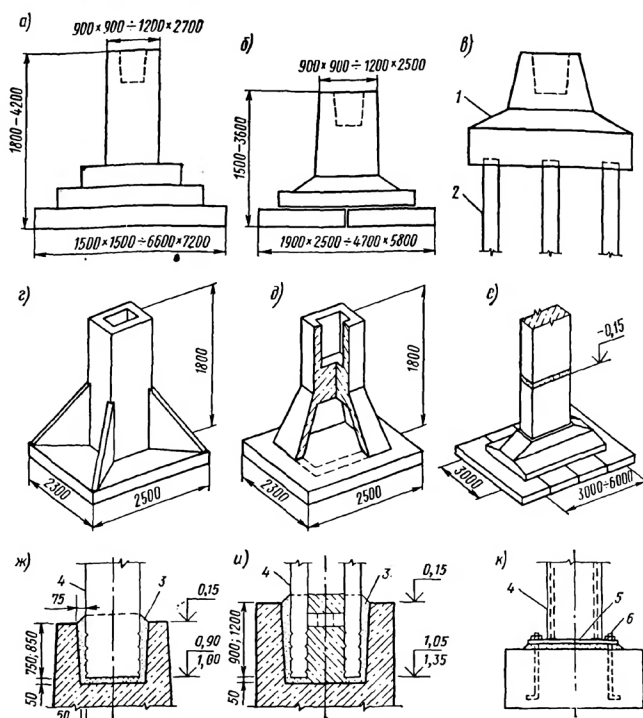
Железобетонные фундаменты и способы заделки в них колонн:
